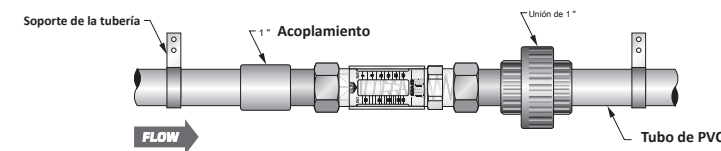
Instalación de soldadura por enchufe de PVC
